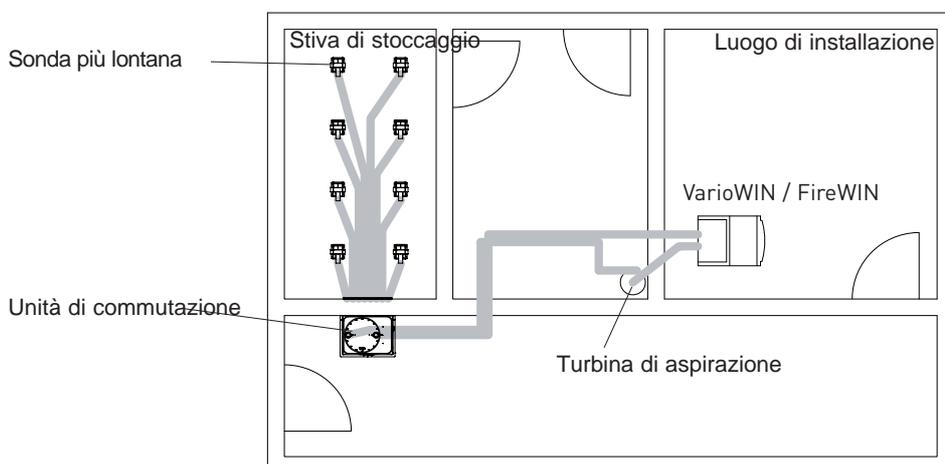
Stiva di stoccaggio, camera di installazione – vista da sopra
